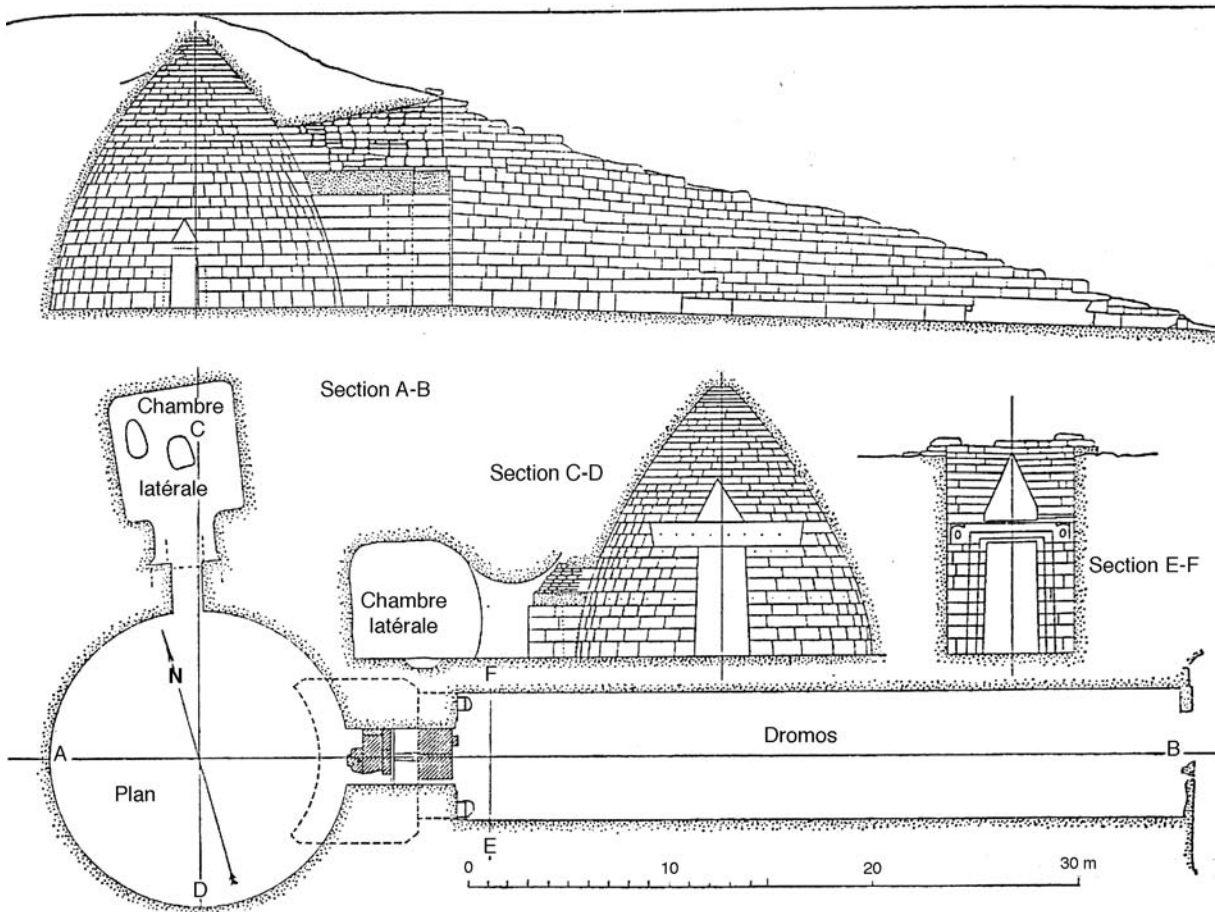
Plan et coupe du tombeau d'Agamemnon à Mycènes.
